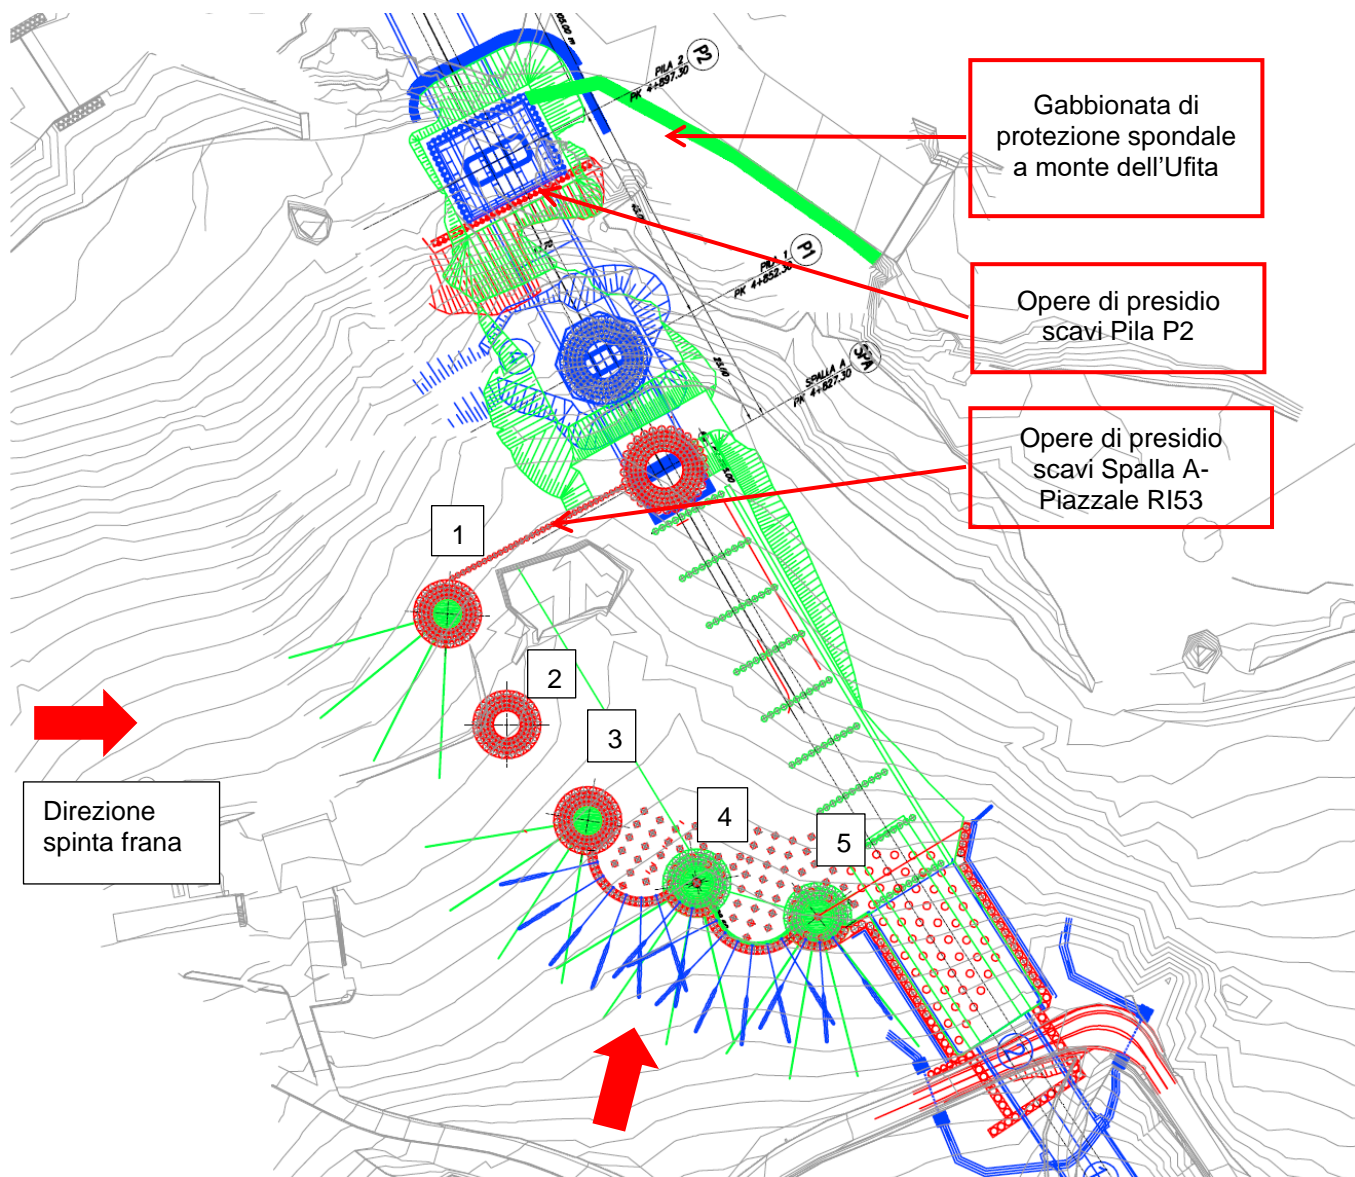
Opere di presidio degli scavi Spalla A – Pozzo 1 e Pila 2
